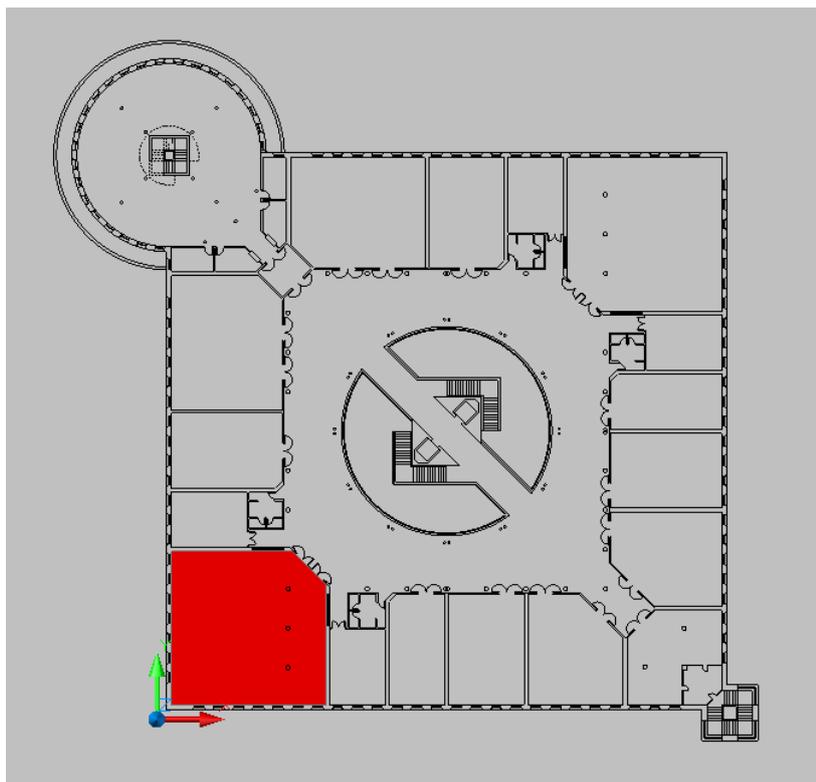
1 Plano de la primera planta de la escuela en 2D
